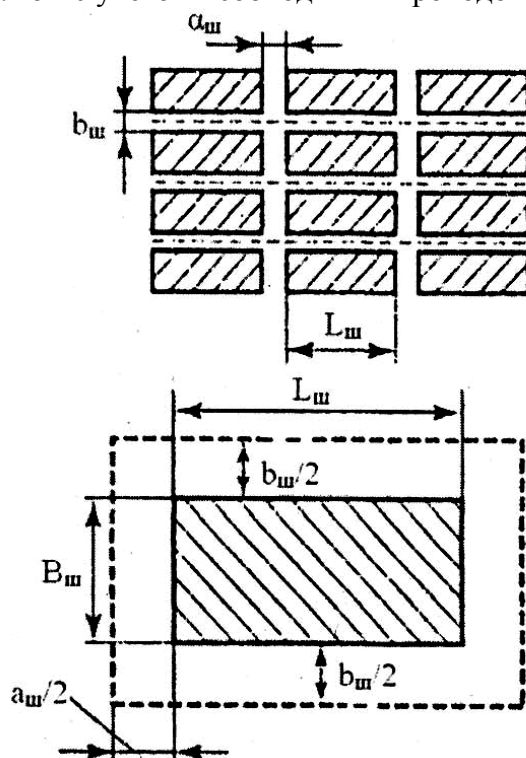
Схема к расчету площади склада и ширины проездов
